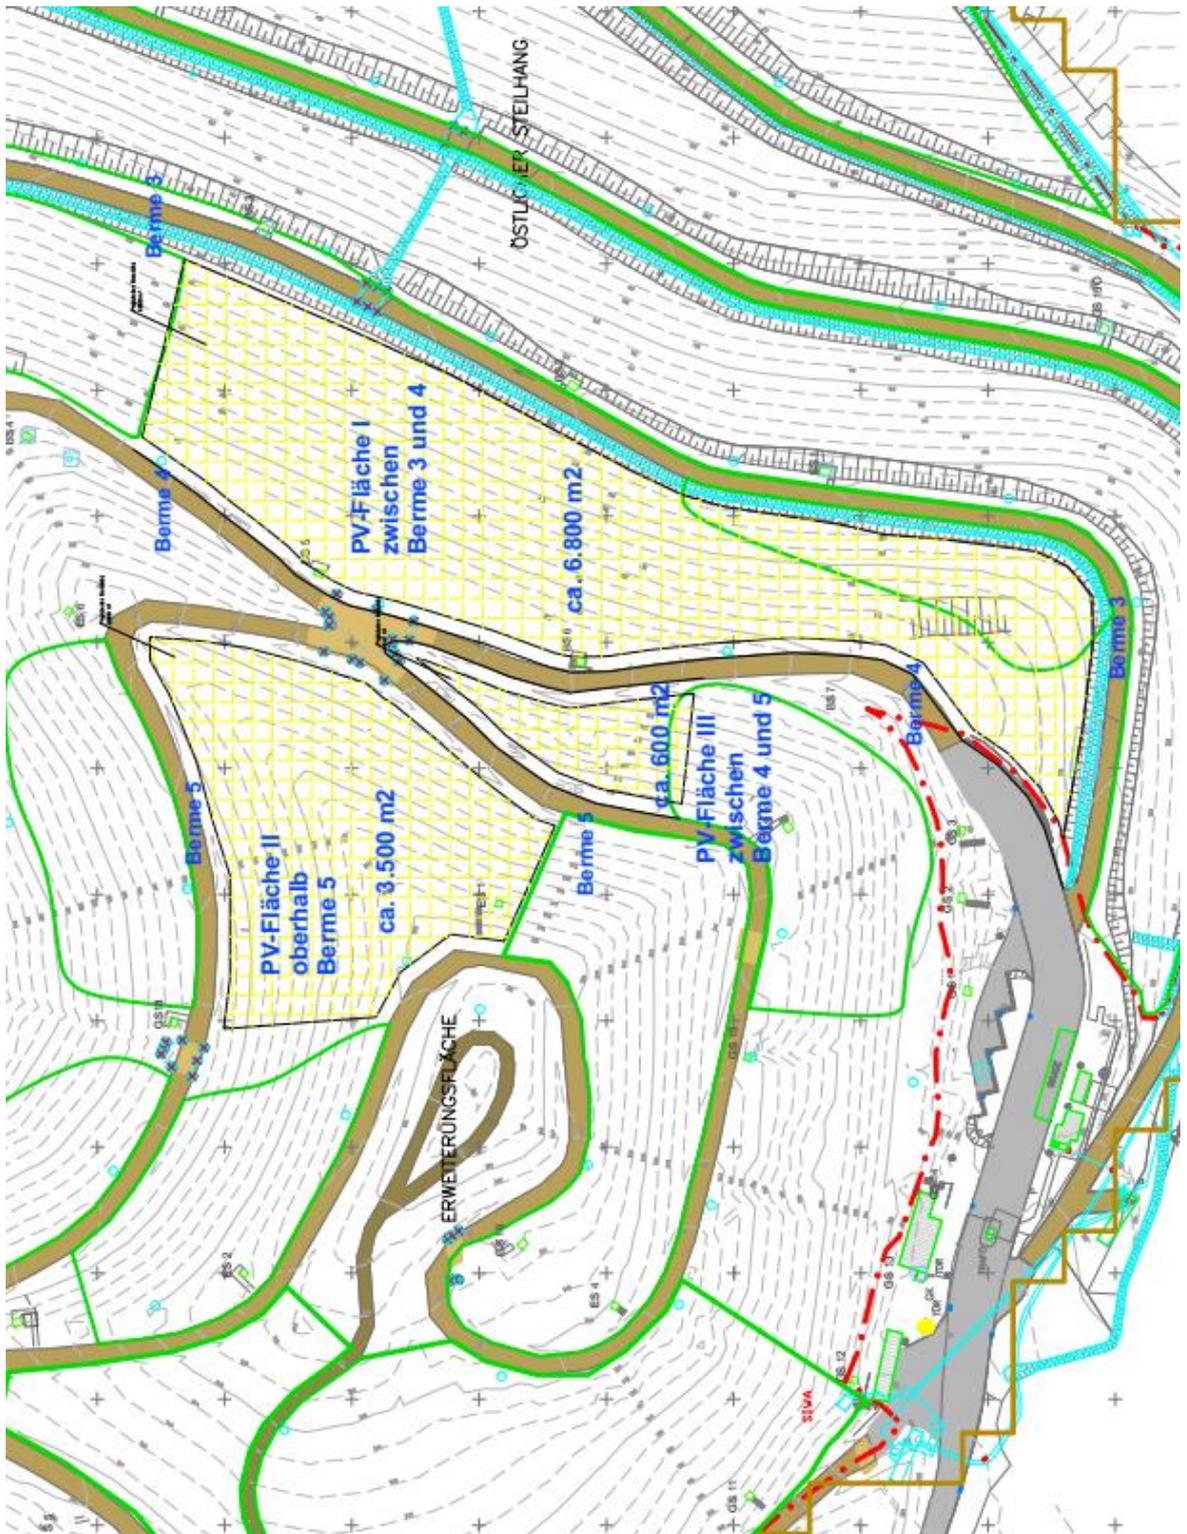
Planausschnitt mit Lage der PV-Flächen I bis III
